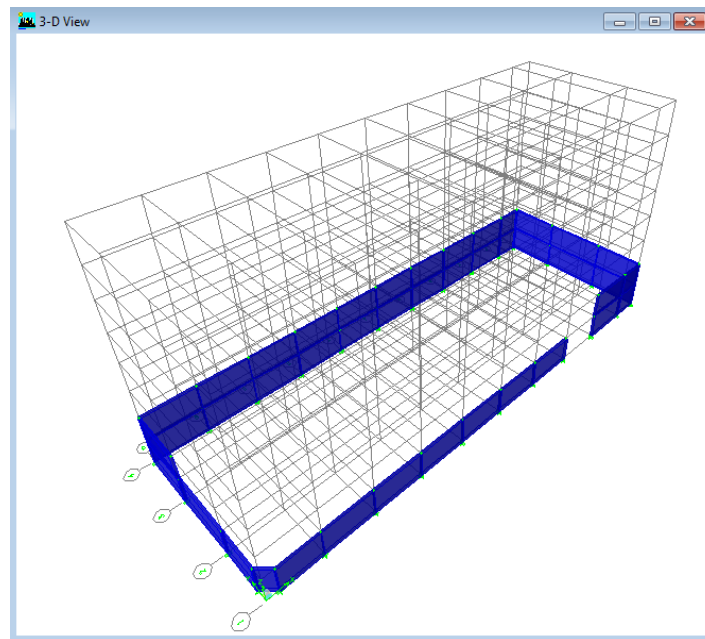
Vista tridimensional de la colocación del muro de sótano
